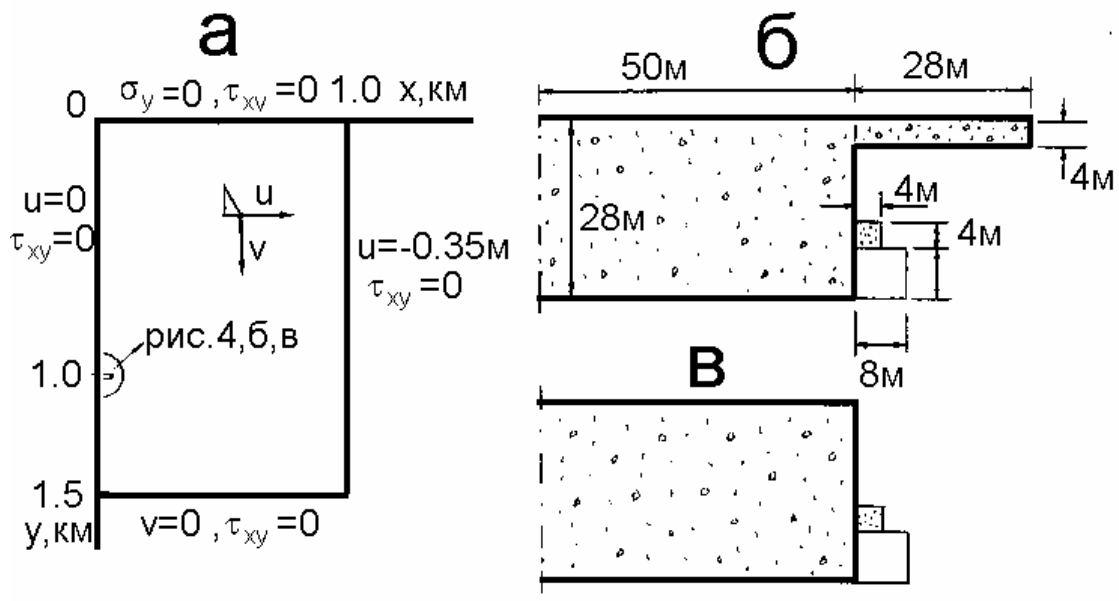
Расчетная область (а) и варианты создания комбинированной кровли очистной выработки при надработке залежи (б) и без нее (в).
